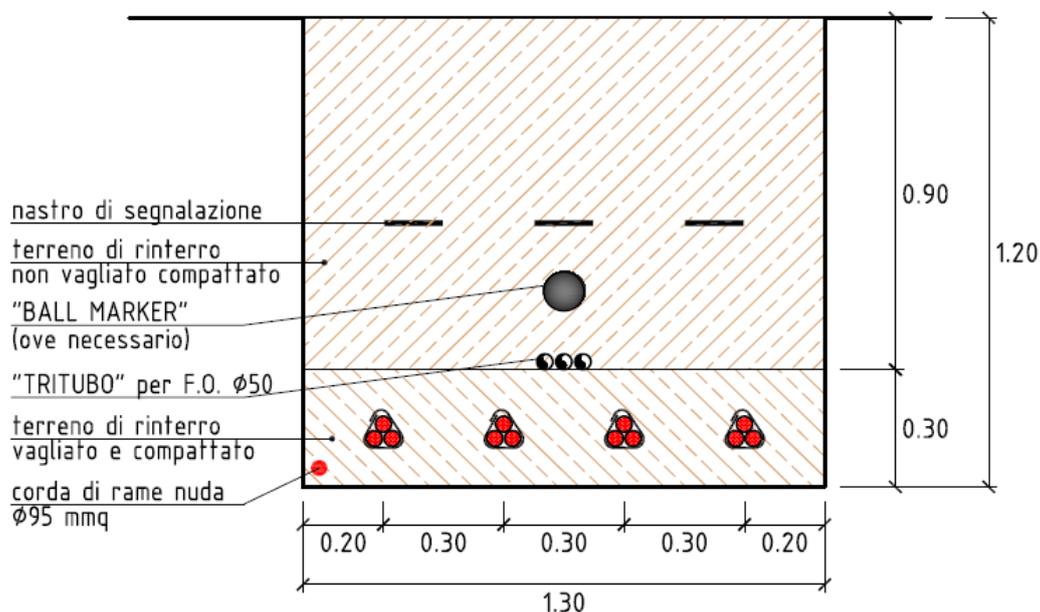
Sezione tipo cavidotto in quadrupla terna
